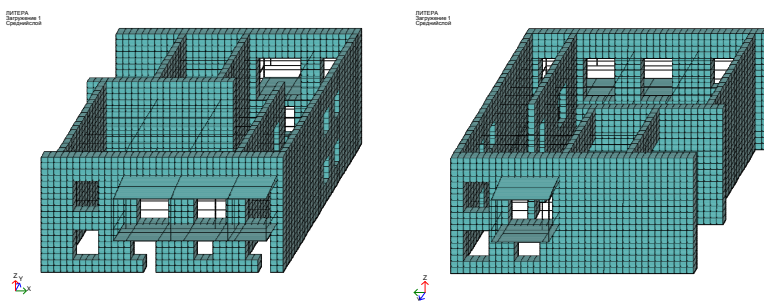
Расчетная модель фрагмента здания с устройством новых балконов и расширением проемов
